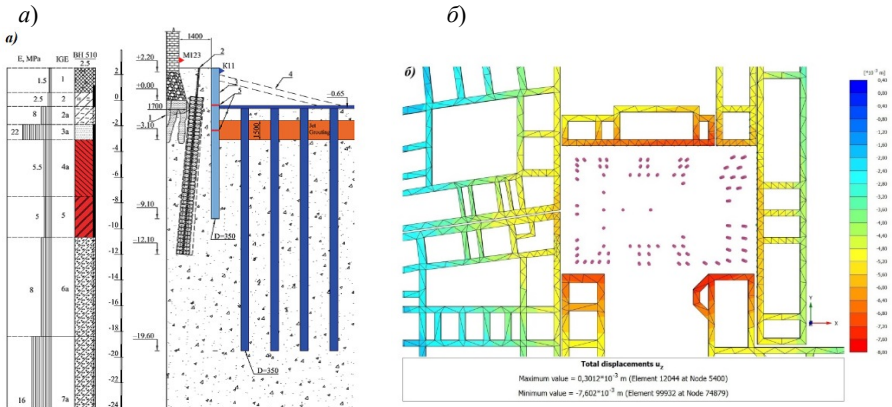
Разработанные конструктивные мероприятия по усилению основания зданий существующей застройки (а), расчетные значения дополнительных осадок зданий окружающей застройки с учетом усиления фундаментов здания (б)
